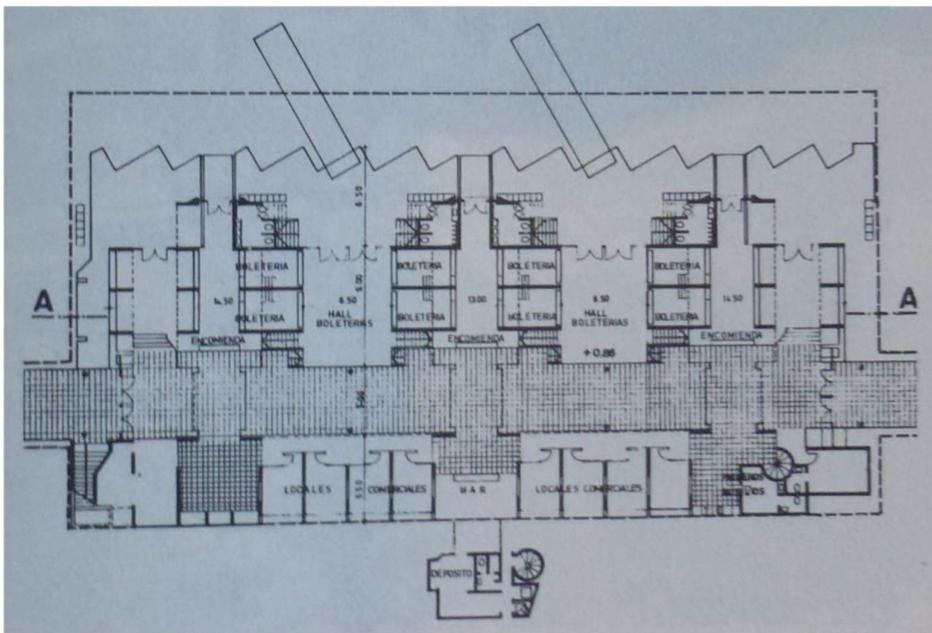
Terminal de Azul. Planta Baja. Fuente: Summa n°203 (1984:49).
